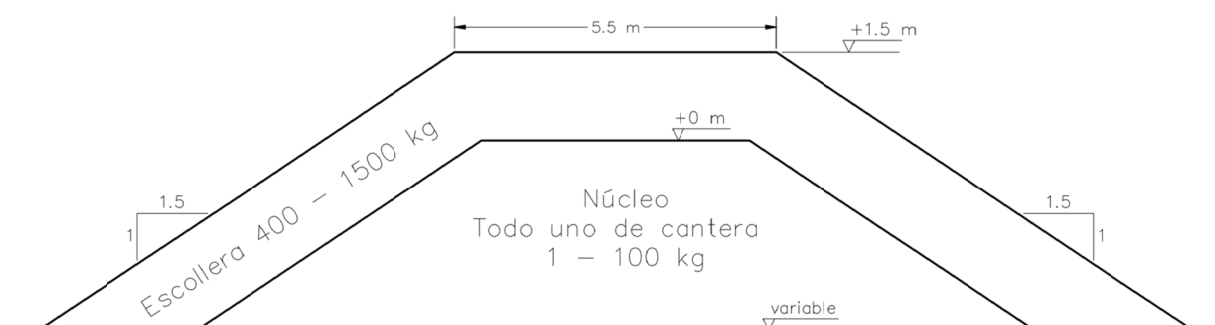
Sección tipo del espigón correspondiente a la línea de actuación local.
